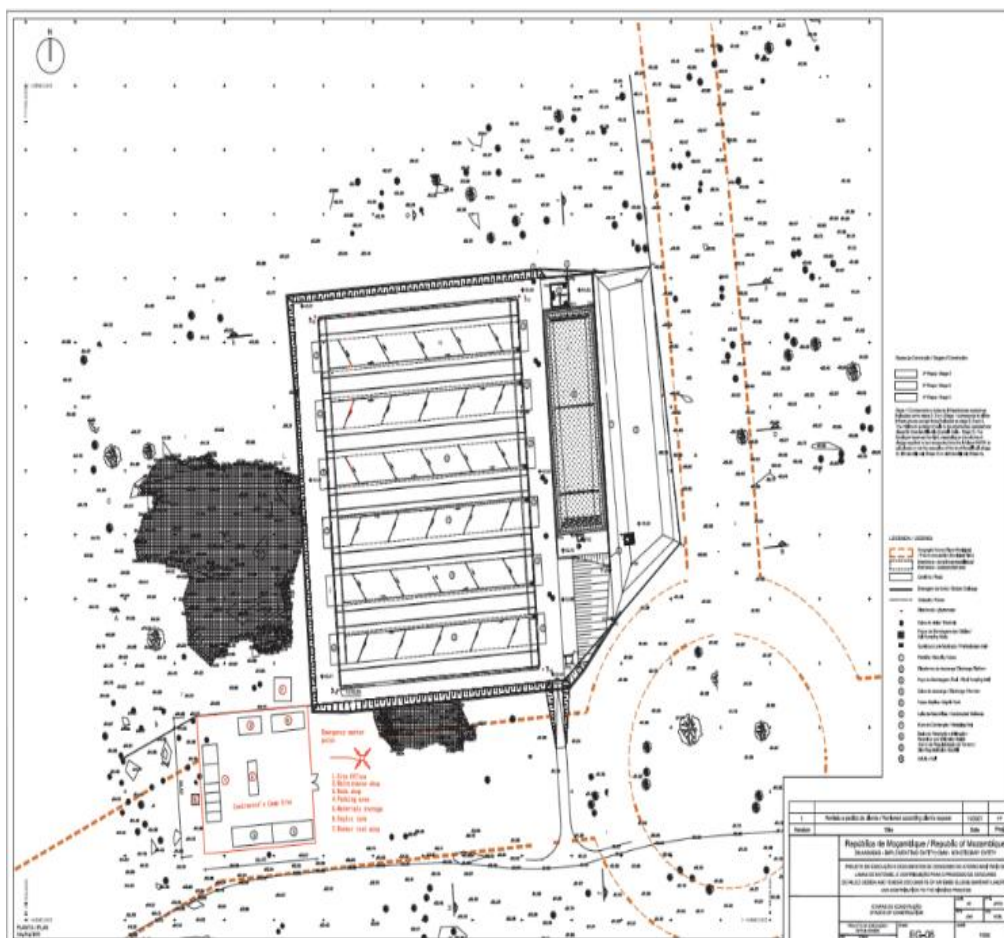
Implantação do Projecto de depósito de lamas Fecais
